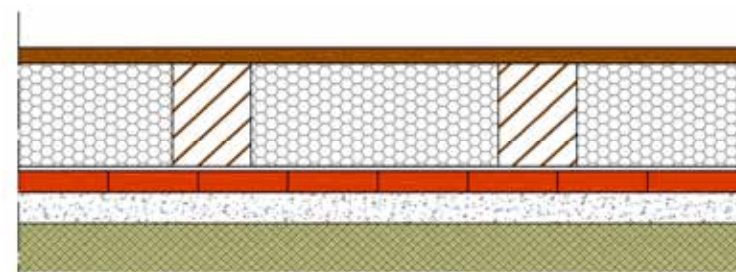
sopra la pavimentazione esistente (rosso) si posa uno strato isolante e poi la nuova pavimentazione (marrone)
